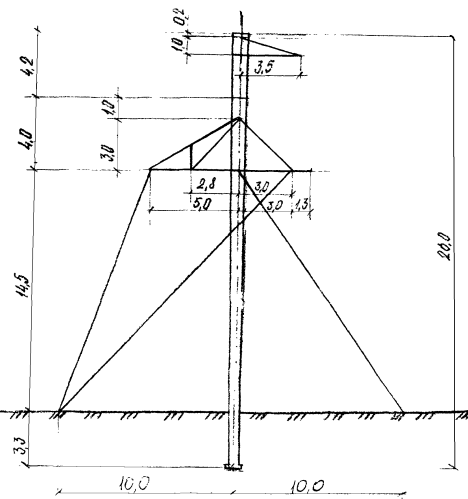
Одноcolumnные железобетонные опоры ВЛ220кВ
